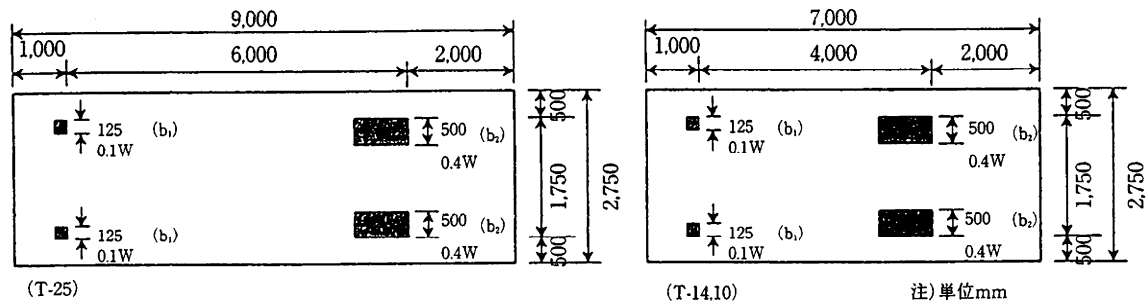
自動車荷重（車輪の位置及び寸法）
